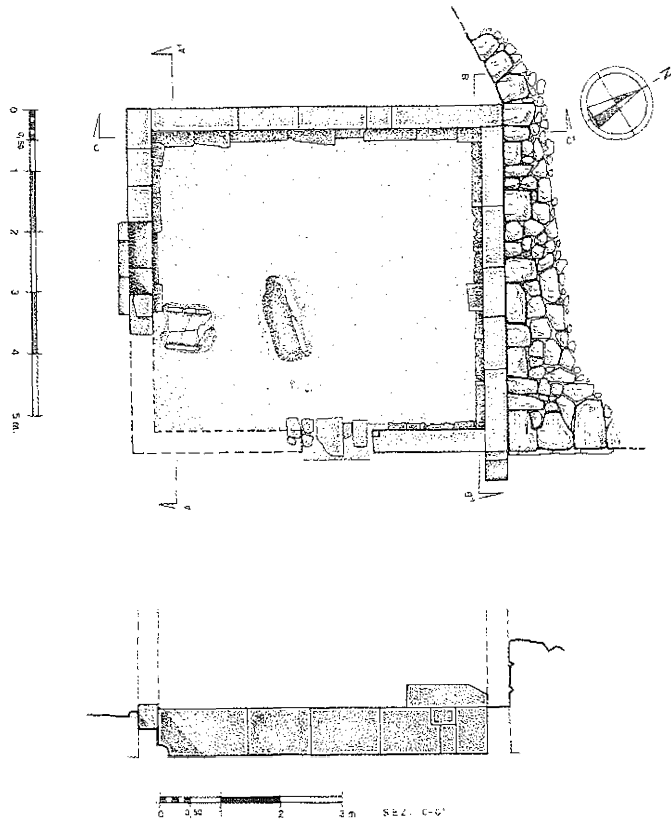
Trebula Balliensis*. Pianta e sezione prospettica dell'*heroon* (da Caiazza 2009c).
